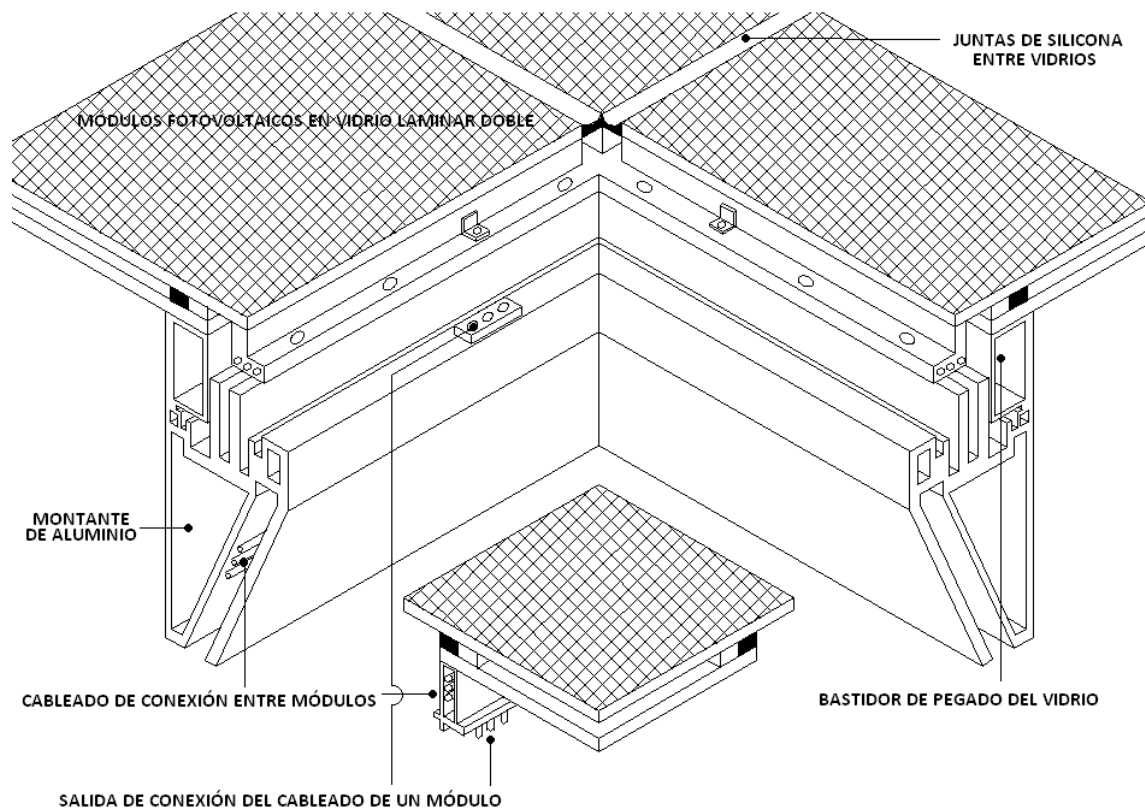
Esquema tipo de una cubierta acristalada fotovoltaica con vidrio fijado mediante encolado estructural.
